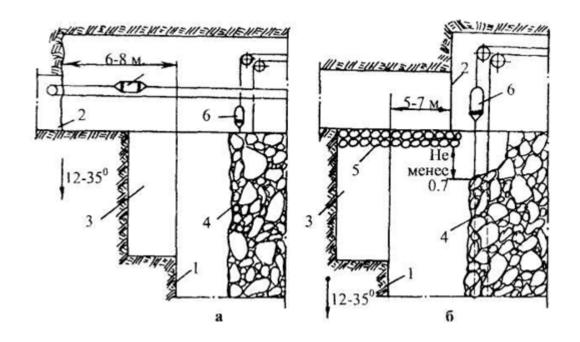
Схемы расположения забоя перекрепления выработки впереди (а) и сзади (б) лавы при выемке полого-наклонных пластов по простиранию:
